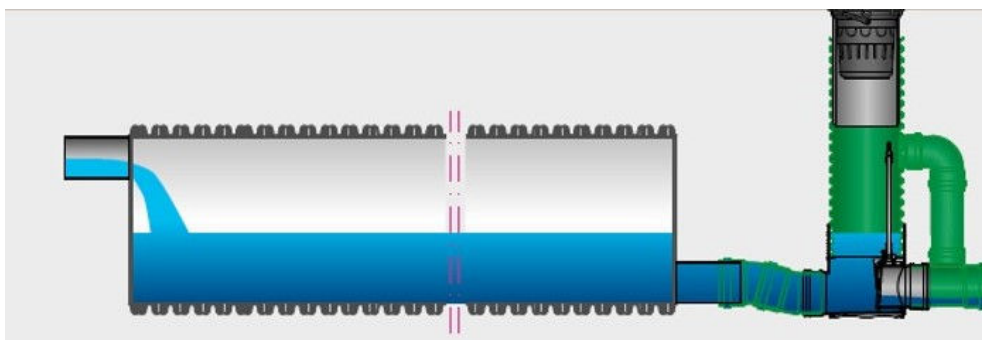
Stauraumkanal aus Kunststoff mit Übergabeschacht
